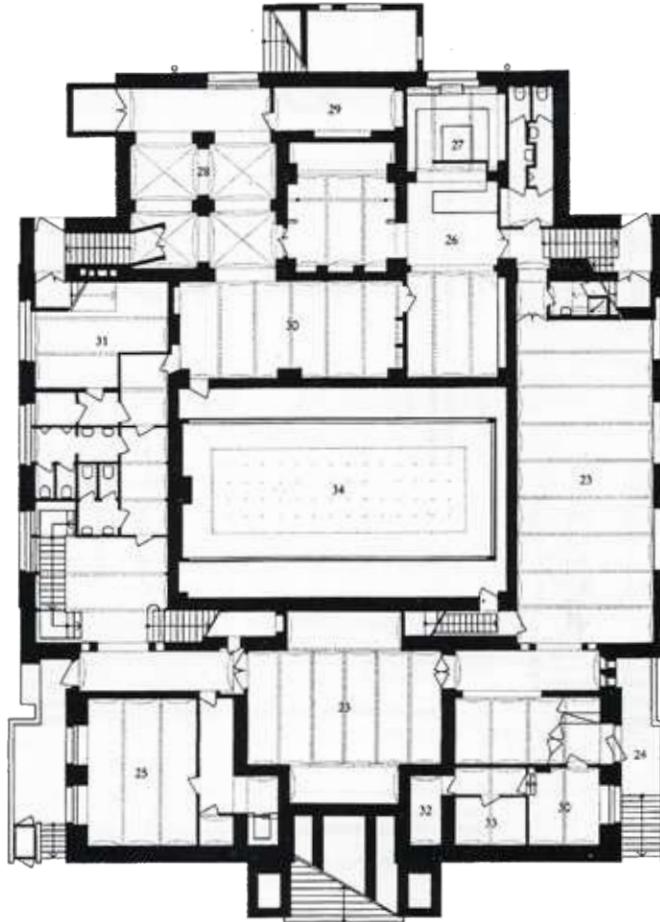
Grundriss Untergeschoss und Klimt-Raum, Maßstab ca.1:350, 1986
